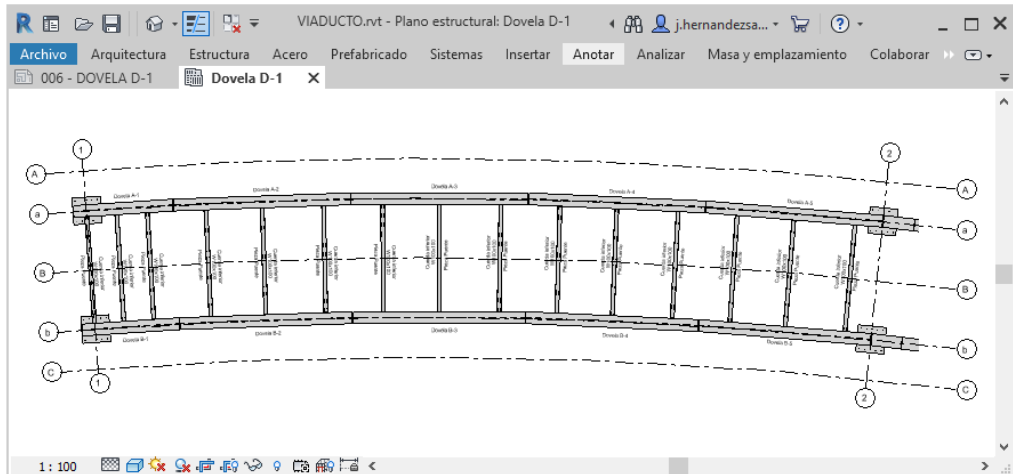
Planta estructural con anotaciones. Fuente: Elaboración propia
